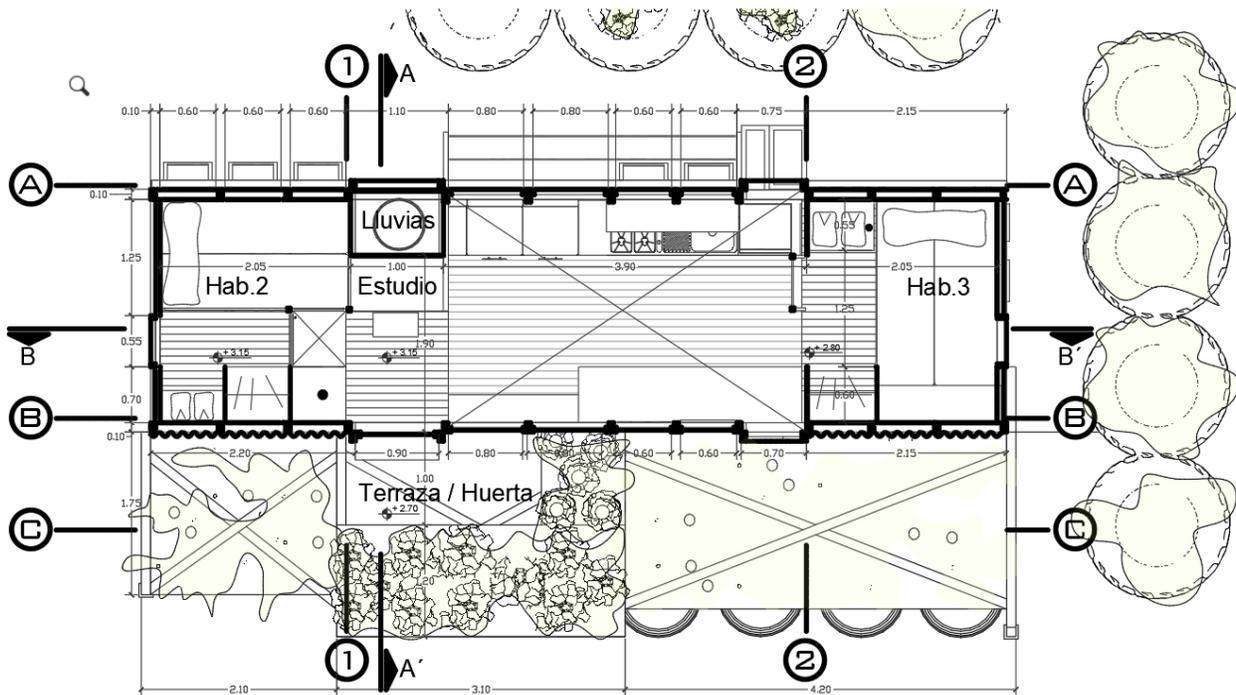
Planta Arquitectónica 1er piso CasaÑa
